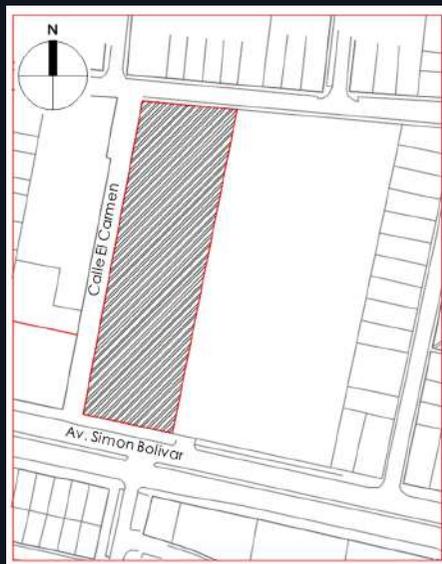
FUENTE: PROPIA. PLANO DE TERRENO ELEGIDO
